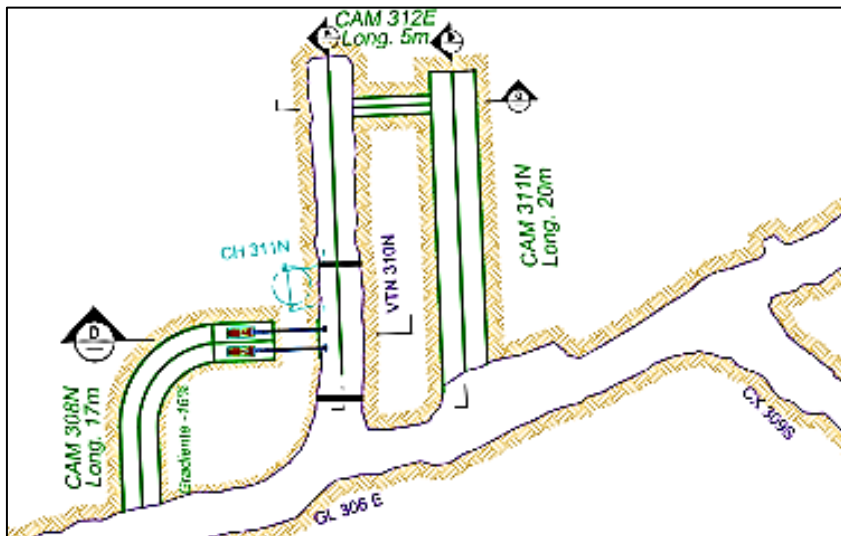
Plano en planta de una cosa de sedimentación en interior mina
